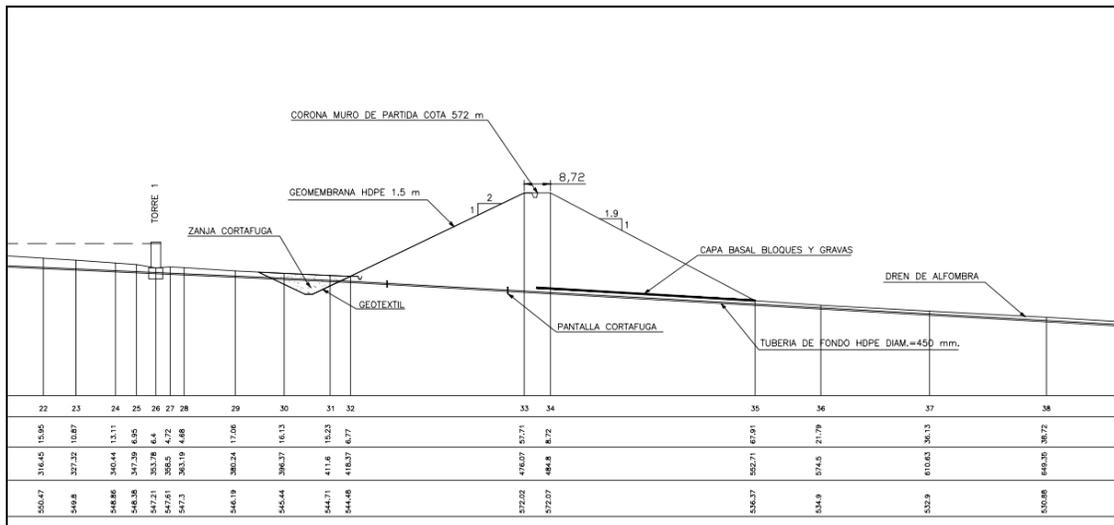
Perfil longitudinal del tranque – zanja cortafuga (Plano PF_LONG_TRQ)
